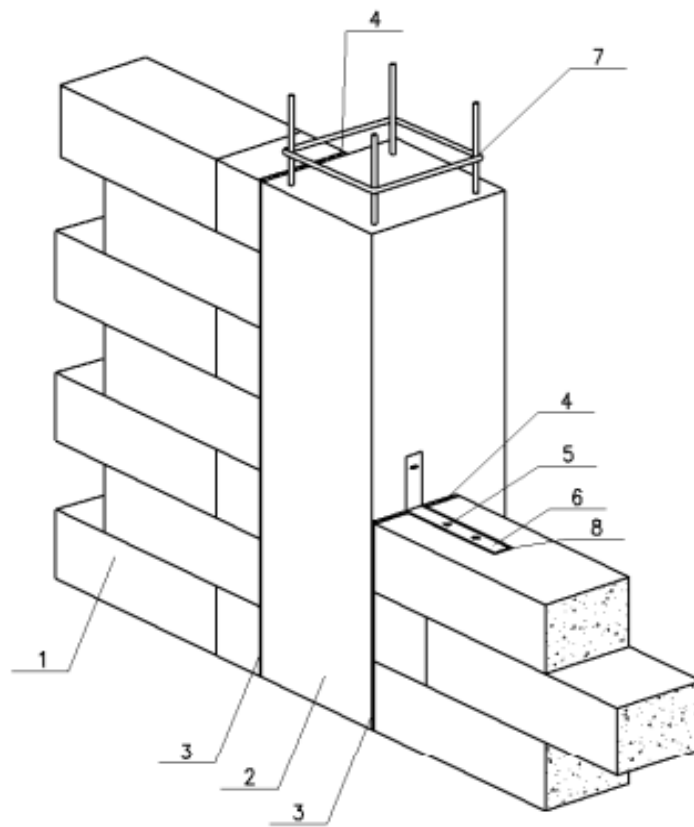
Фрагмент стінової кладки газобетонних блоків при наявності залізобетонних колон, де: 1 – кладка з газобетонних блоків; 2 – залізобетонна колонна; 3 – еластичний силіконовий чи акриловий герметик; 4 – мінераловатний утеплювач товщиною 20 – 25 мм; 5 – анкер; 6 – металевий кутик; 7 – арматурний каркас залізобетонної колони; 8 – штраба в газобетонному блоці під металевий кутик.
